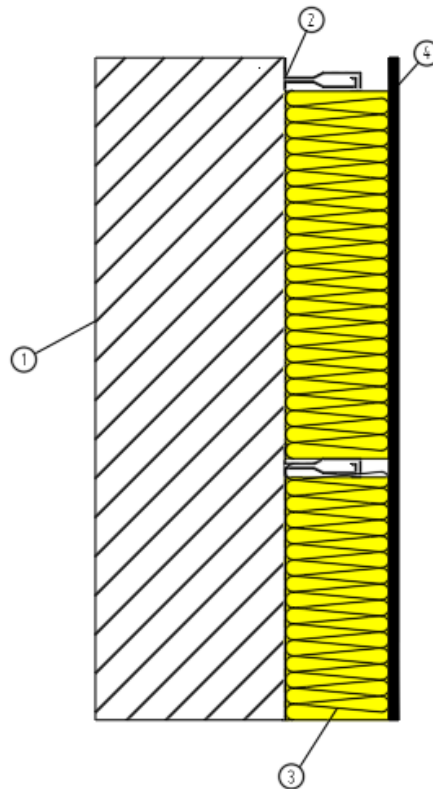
Detalle Constructivo de la Fachada en Contacto con el Exterior
